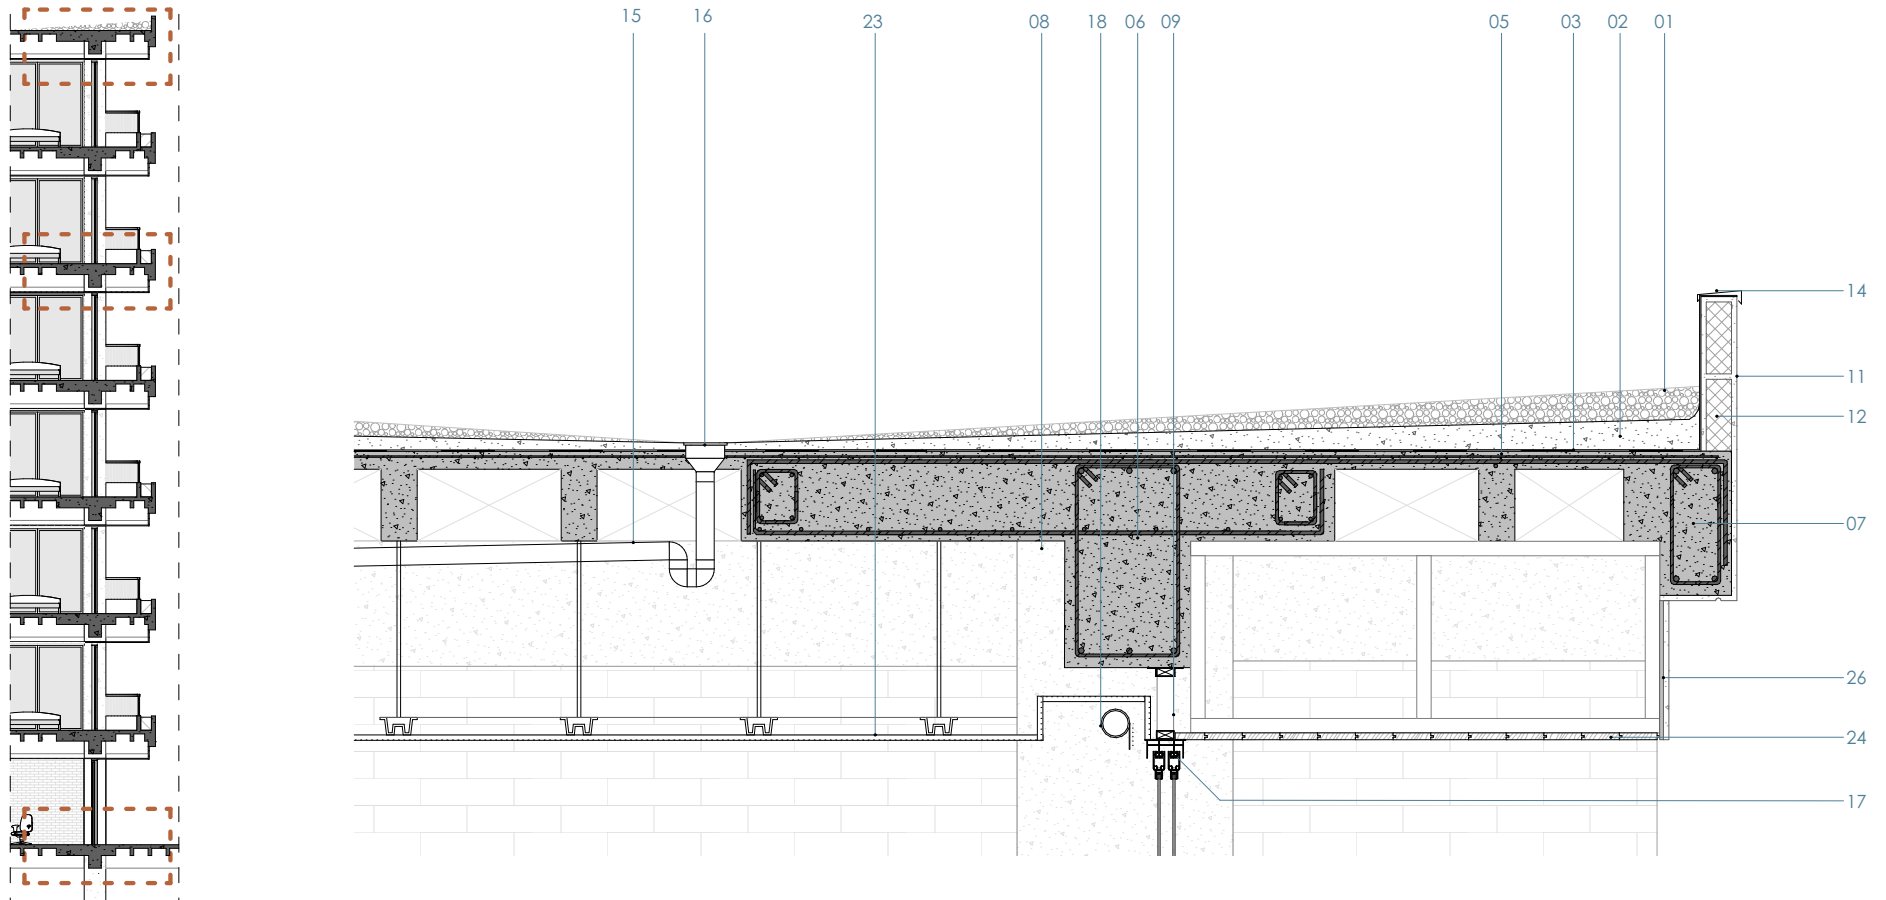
Detalle constructivo Escala 1:20 REMATE Fuente: Elaboración Propia 2026
